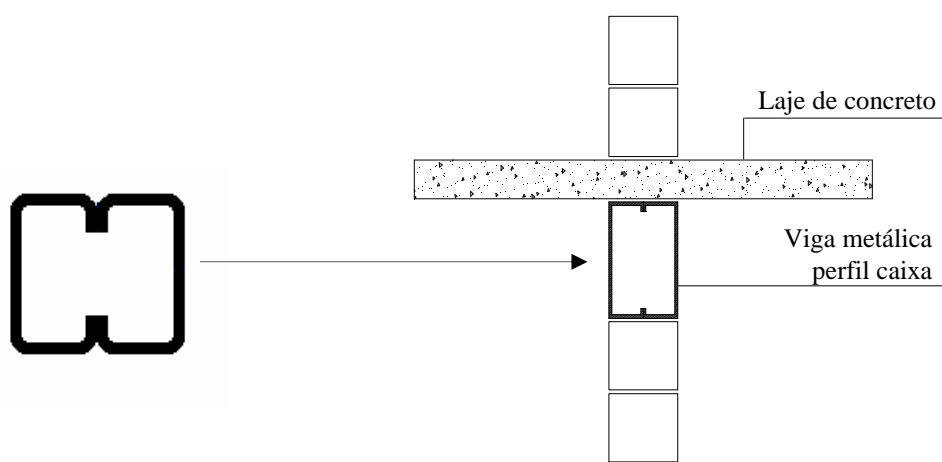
Perfil caixa isolado e entre parede e laje.
